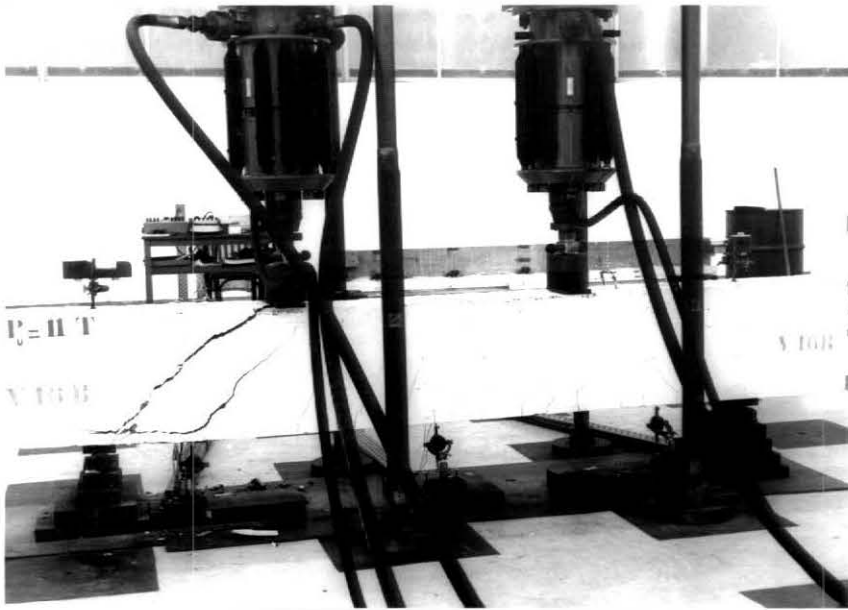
Ruptura da viga 16B ($a/d=1,6$) por destruição da ancoragem da armadura longitudinal, associada com esmagamento do concreto na zona comprimida.
